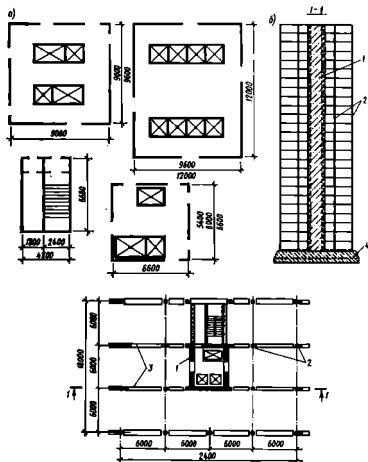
Конструктивные схемы каркасных зданий с монолитными ядрами жесткости: а — варианты компоновки ядер жесткости; б — проект 25-этажного жилого дома в Москве; 1 — монолитное ядро жесткости; 2 — колонны каркаса; 3 — ригели; 4 — фундамент
